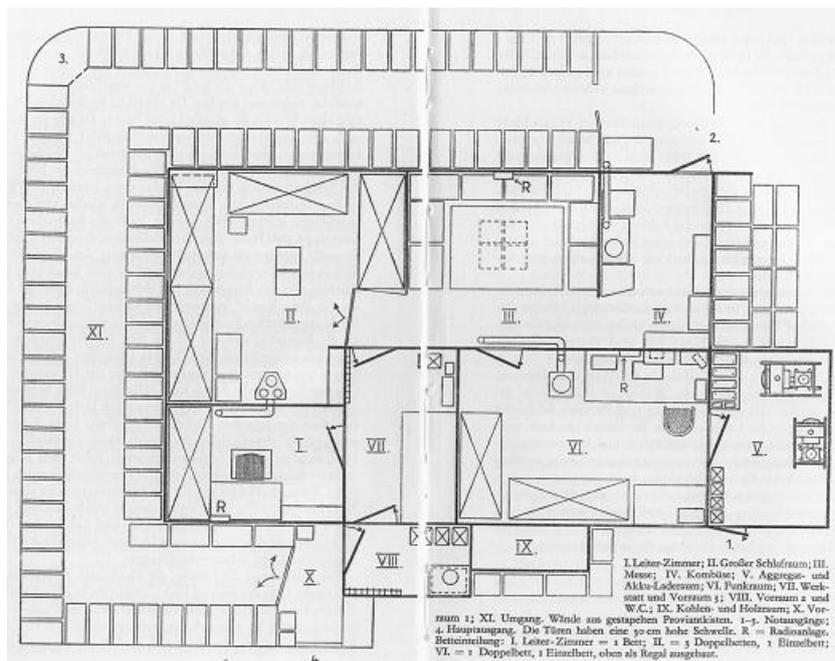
Der Grundriss der Stationshütte „Haudegen“ mit Inneneinrichtungen.
